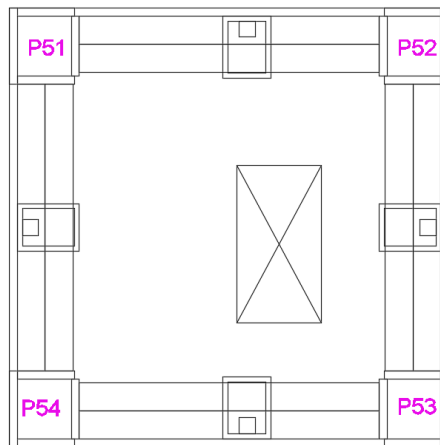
15 Planta estructura quinto nivel Torre del Reloj de Iquique
